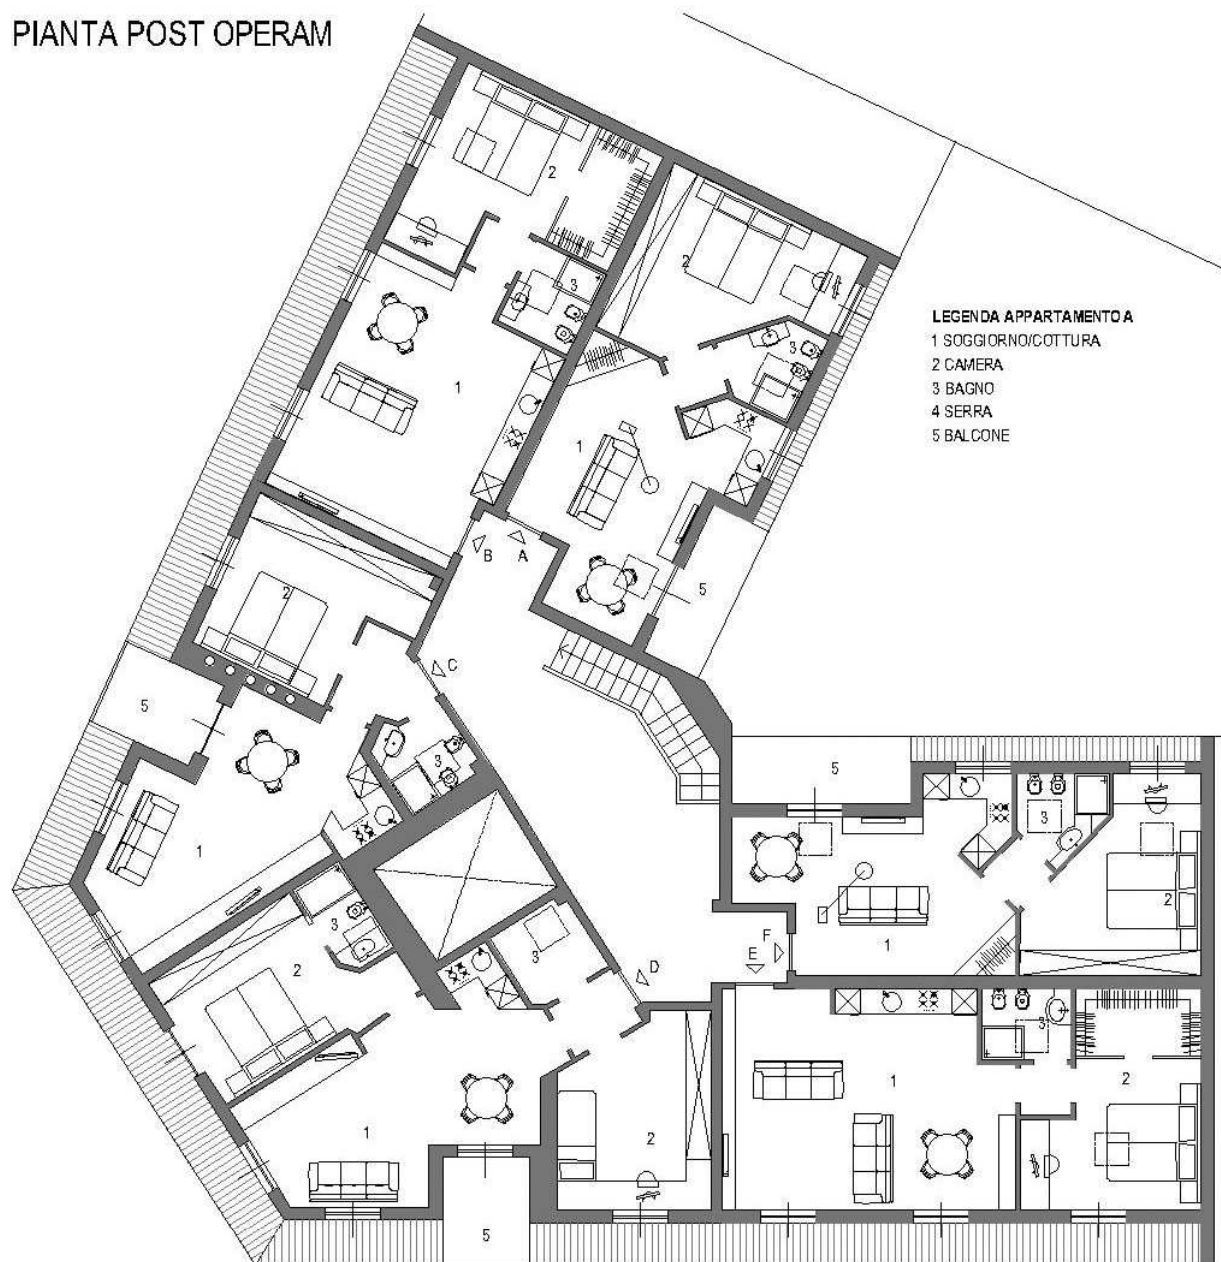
Planimetria delle sei unità immobiliari realizzate nel sottotetto
